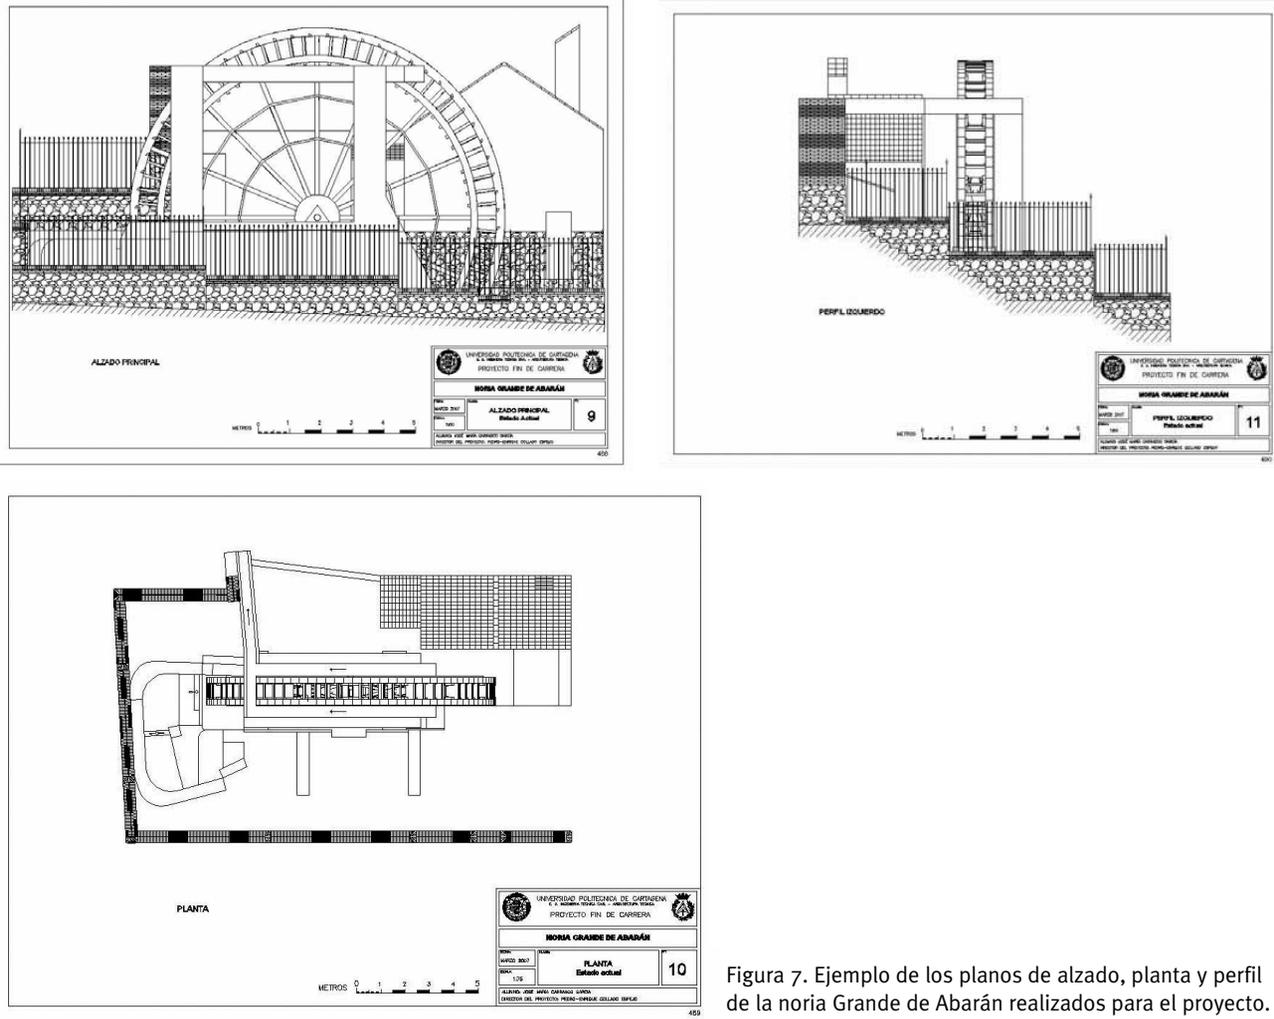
Ejemplo de los planos de alzado, planta y perfil de la noria Grande de Abarán realizados para el proyecto.
